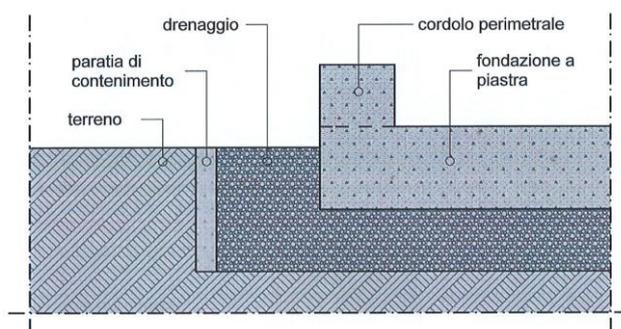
Esempio di drenaggio perimetrale del terreno su fondazione a piastra. (fonte: CasaAttiva)
